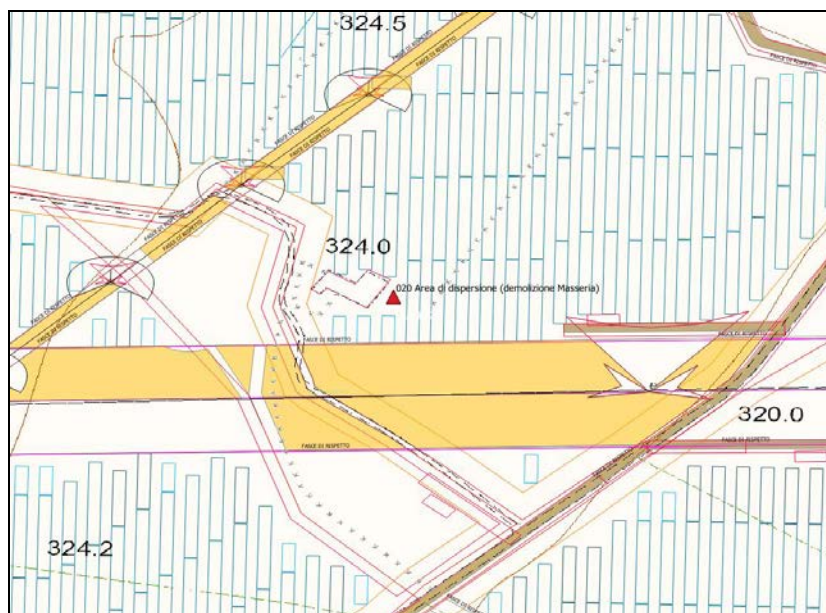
Posizionamento dell'evidenza 020 rispetto al progetto d'impianto dei pannelli fotovoltaici.
